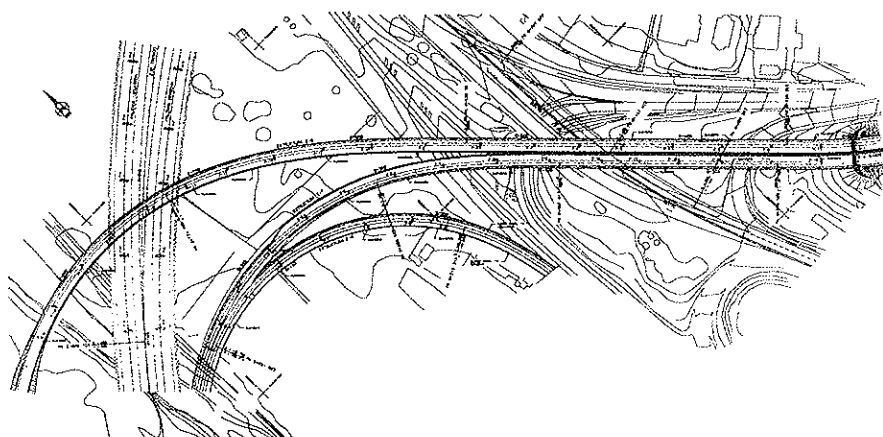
Viaductos de conexión entre la M-40 y la Avenida de la Ilustración M-30. Planta.
